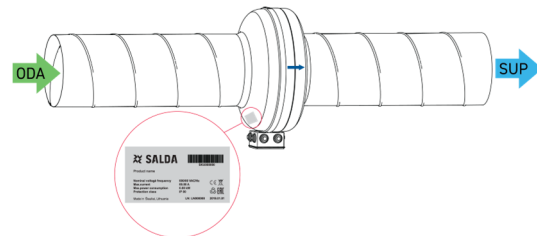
Umístění technického štítku VKSA a směr proudění vzduchu
